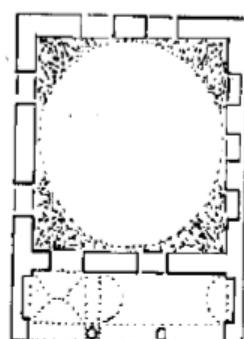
مقطع أفقي لمسجد طاش في قونية
